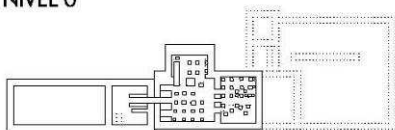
Levantamiento planimétrico (2D) con la herramienta de AutoCad
